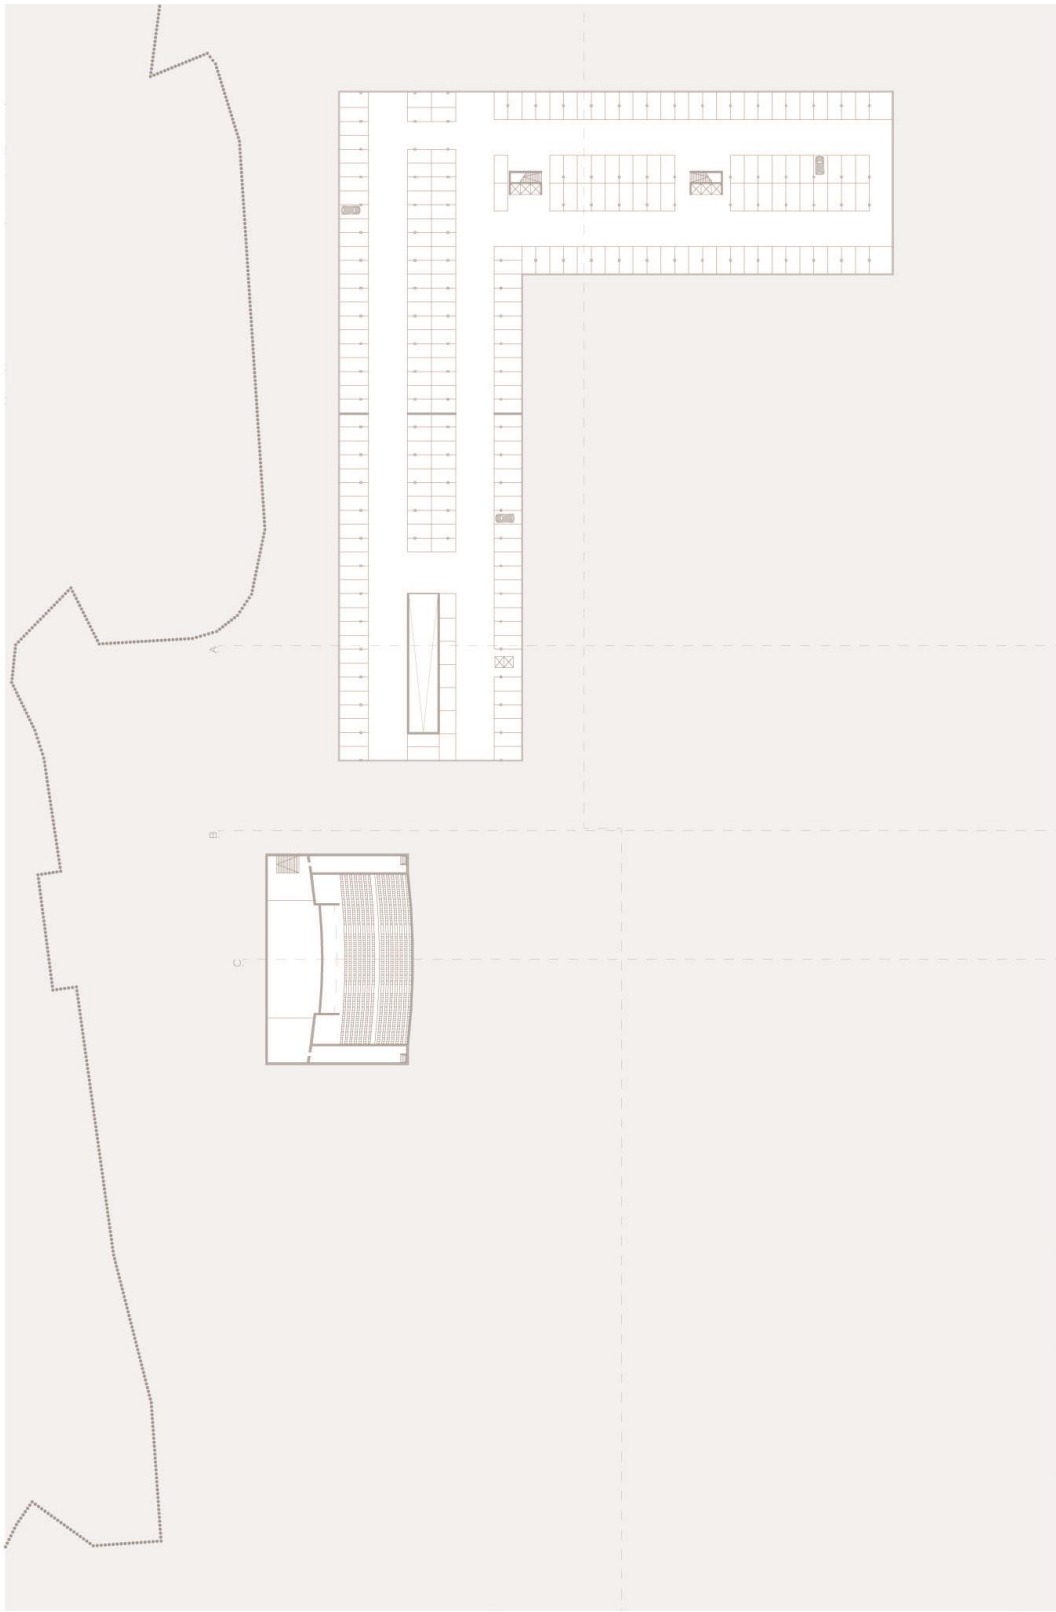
Planta piso -1, cota 1.5. Fonte: Autora
